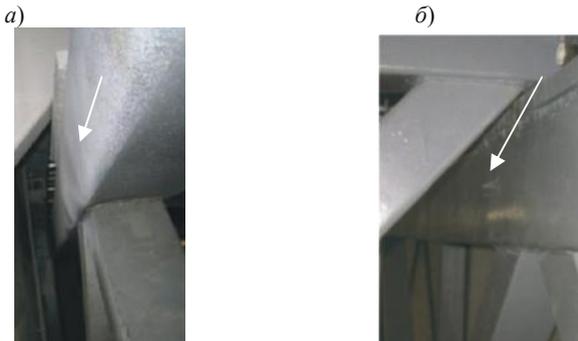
Потеря местной устойчивости стенок сечения верхнего пояса подстропильной фермы ПФ Б 1-2 в месте опирания стропильной фермы Ф А-Б- 1/2 со стороны пролета Б-В (а) и подстропильной фермы ПФ Б 4-5 в месте опирания стропильной фермы Ф А-Б- 4/5 со стороны пролета А-Б (б)
